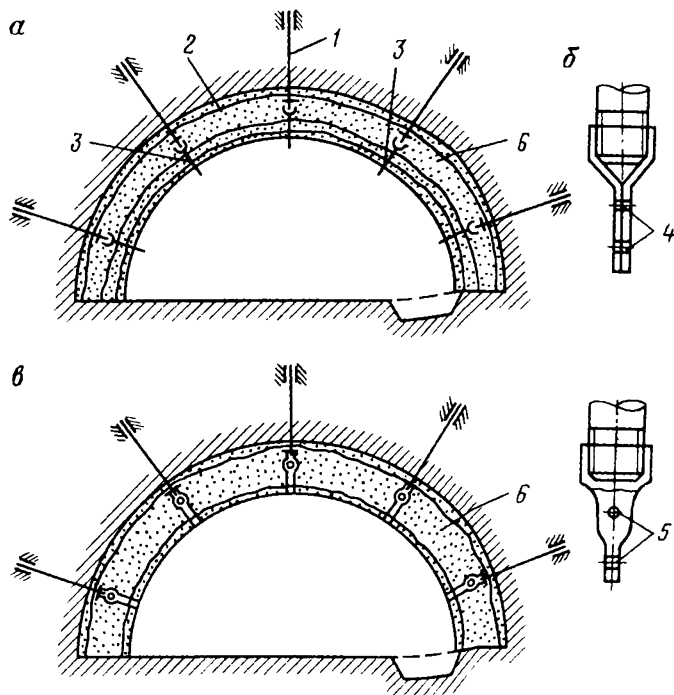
Анкерно-набрызгбетонная крепь с многослойной арматурой (а, в) и устройства для возведения металлического каркаса (б)
